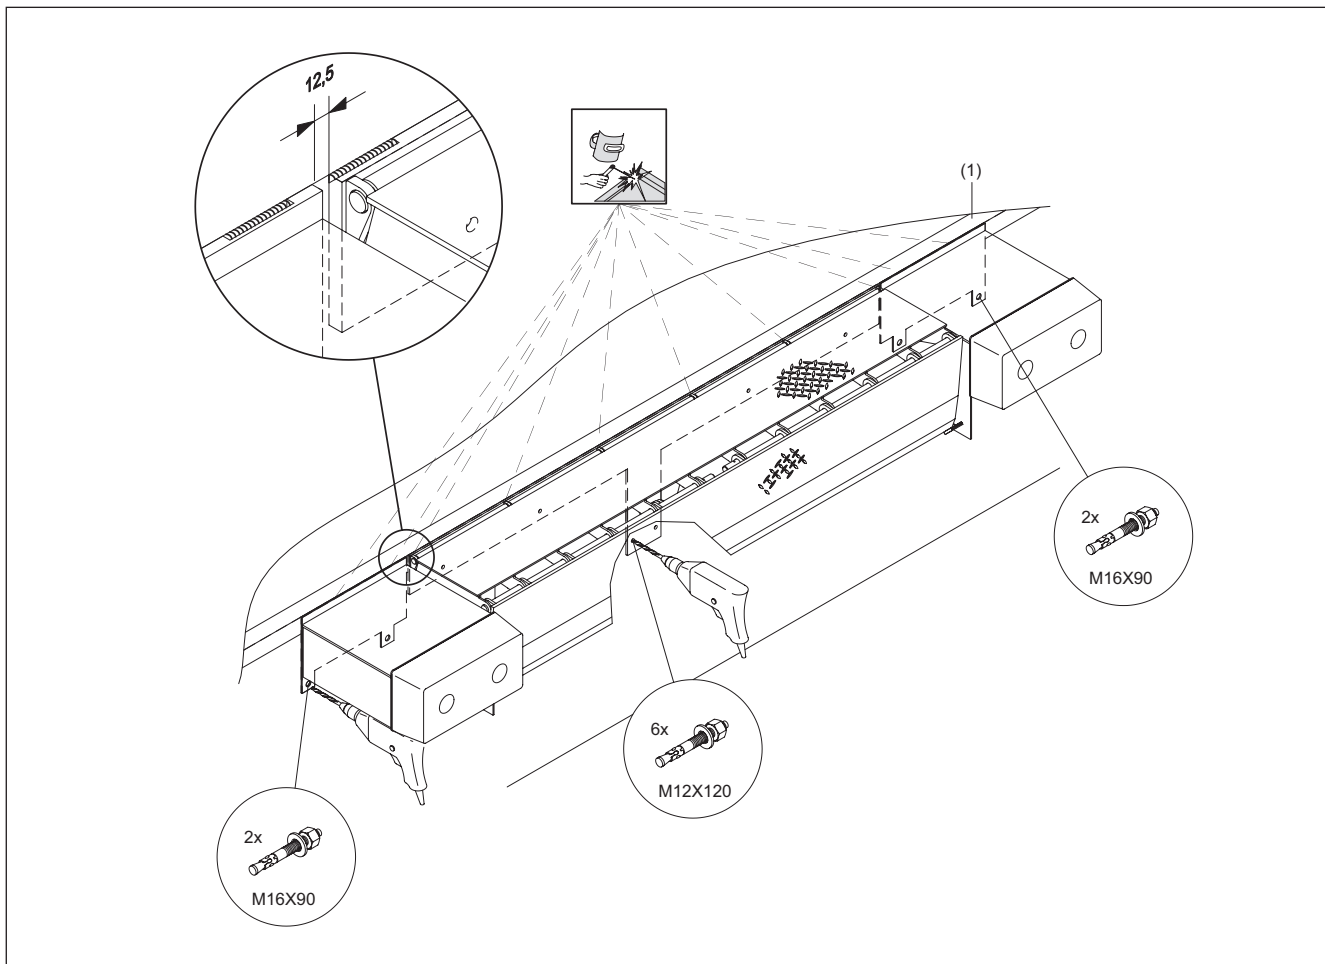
Конструкция MRS-H для монтажа сваркой перед зданием
